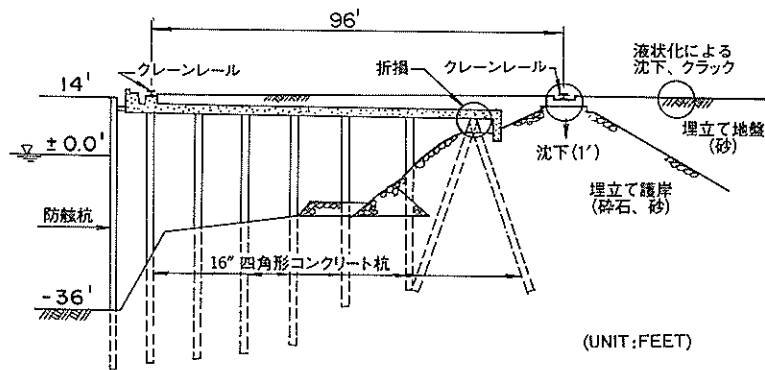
7th Street ターミナルの岸壁 (バース35~38, 40) の標準断面図
